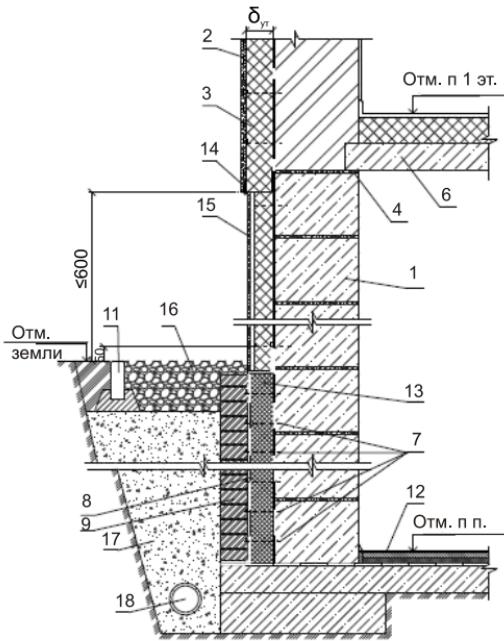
Вариант с дренажем и защитной гидроизоляцией кирпичной кладки
